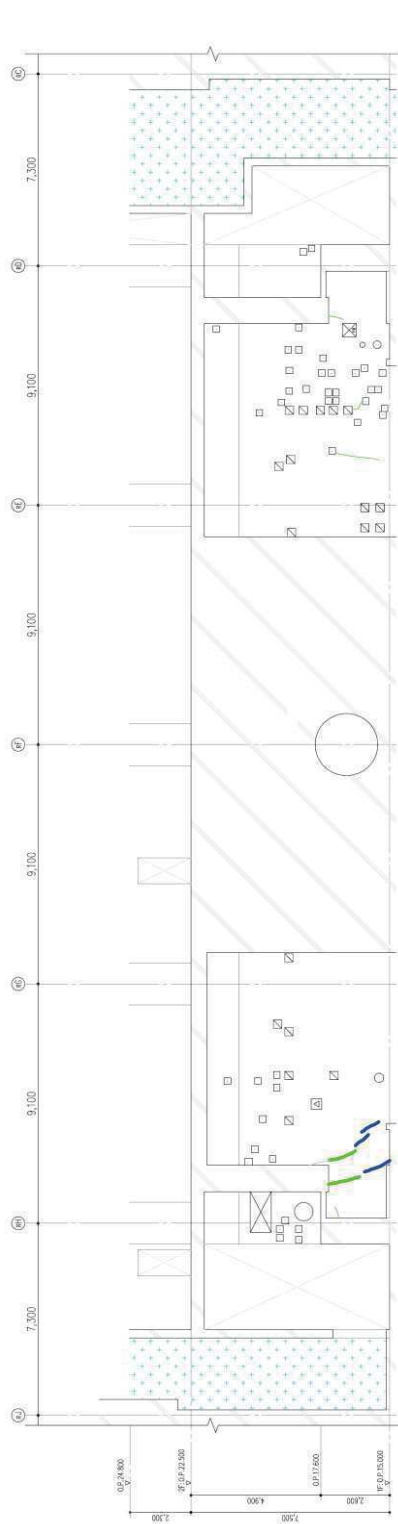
原子炉建屋のひび割れ分布 耐震壁 (29) 地上 1 階 R1 通り
